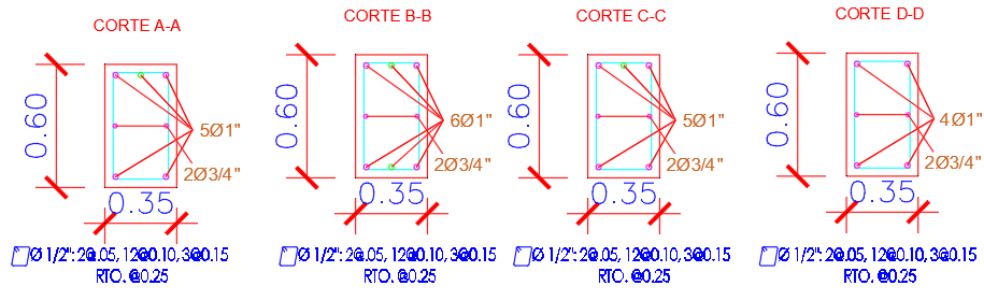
Secciones de Viga con Refuerzo 1° Piso
